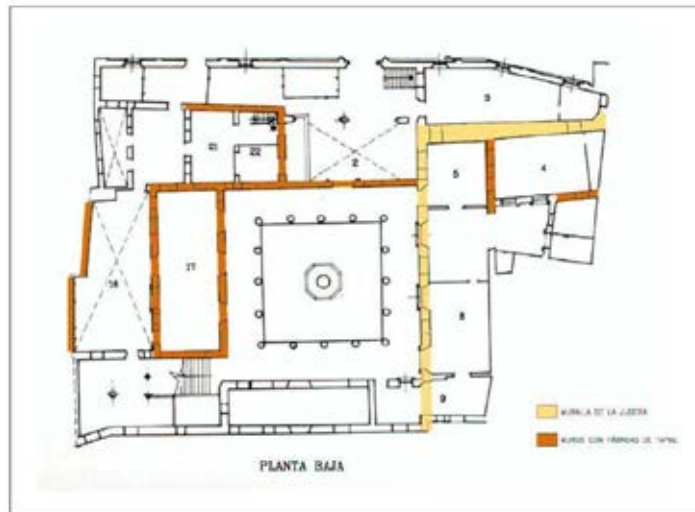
Casa de Miguel de Mañara. Planta baja. Muros constatados en tapial
